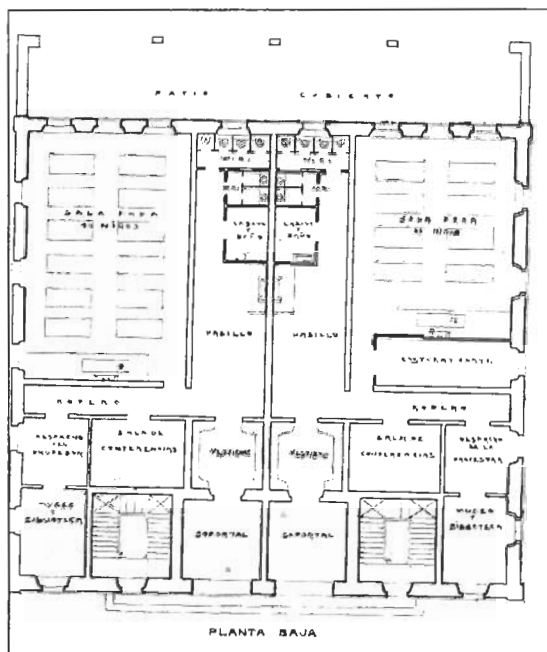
Planta baja del proyecto de escuela para San Pedro.
